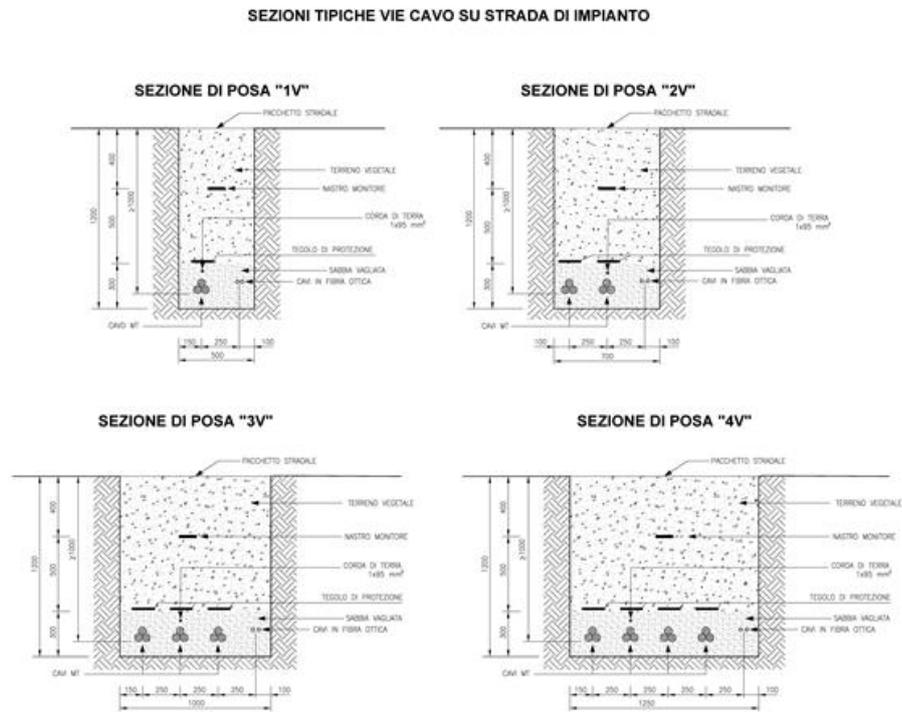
Sezioni di posa cavidotti su strada di impianto
